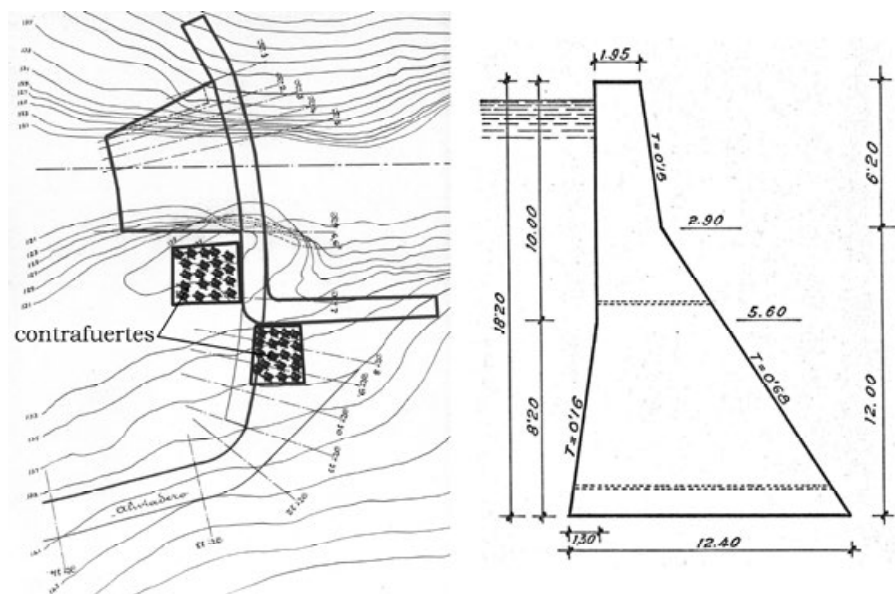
Planta y perfil tipo de La Vieja en La Gomera (JG)
